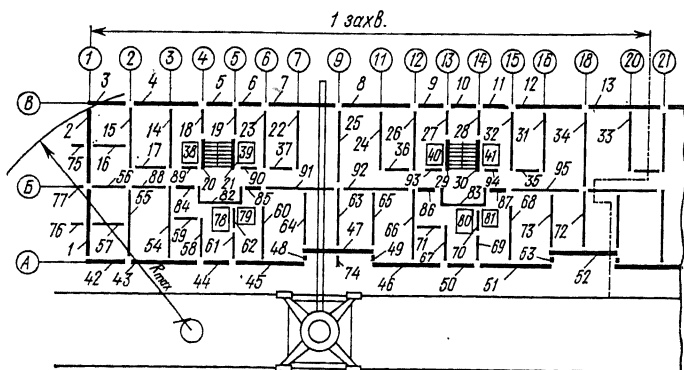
Схема монтажа панельного 9-этажного 4-секционного жилого дома серии П-49
